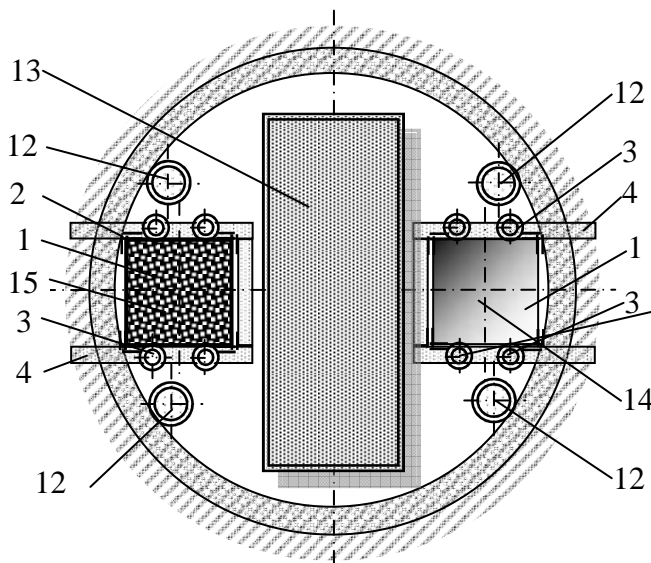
Поперечное сечение ствола с гидродомкратным подъемом
